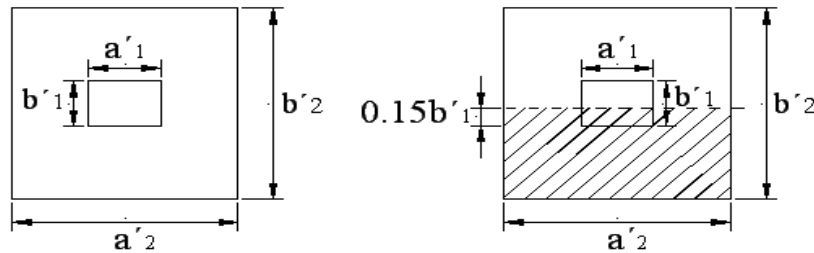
Zapata centrada (diseño a flexión en la dirección Y-Y).
